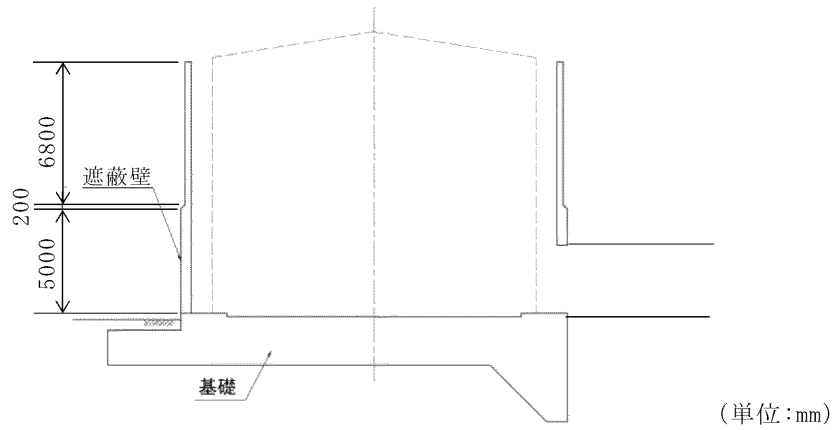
復水貯蔵タンク遮蔽壁 断面図 (A-A断面)
